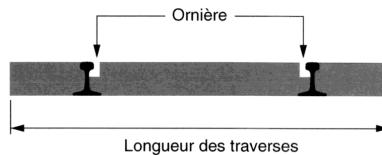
Dimensions de la surface de croisement des passages à niveau - coupe transversale
